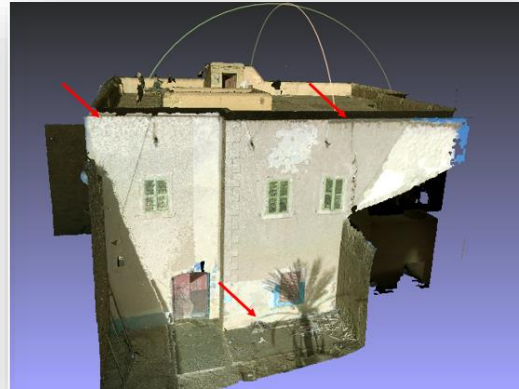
Erosion de tête et du bas du mur sur la façade Sud de la maison Ben Hassine image 3D Mesh Lab. Source : Auteure.2022.
